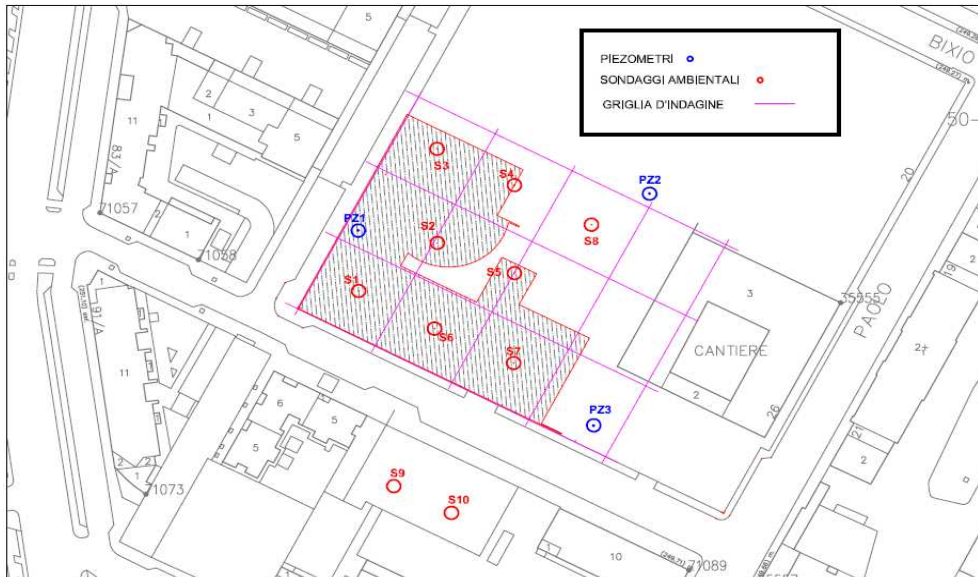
Planimetria generale dell'area con ubicazione delle indagini effettuate Area Energy Center
